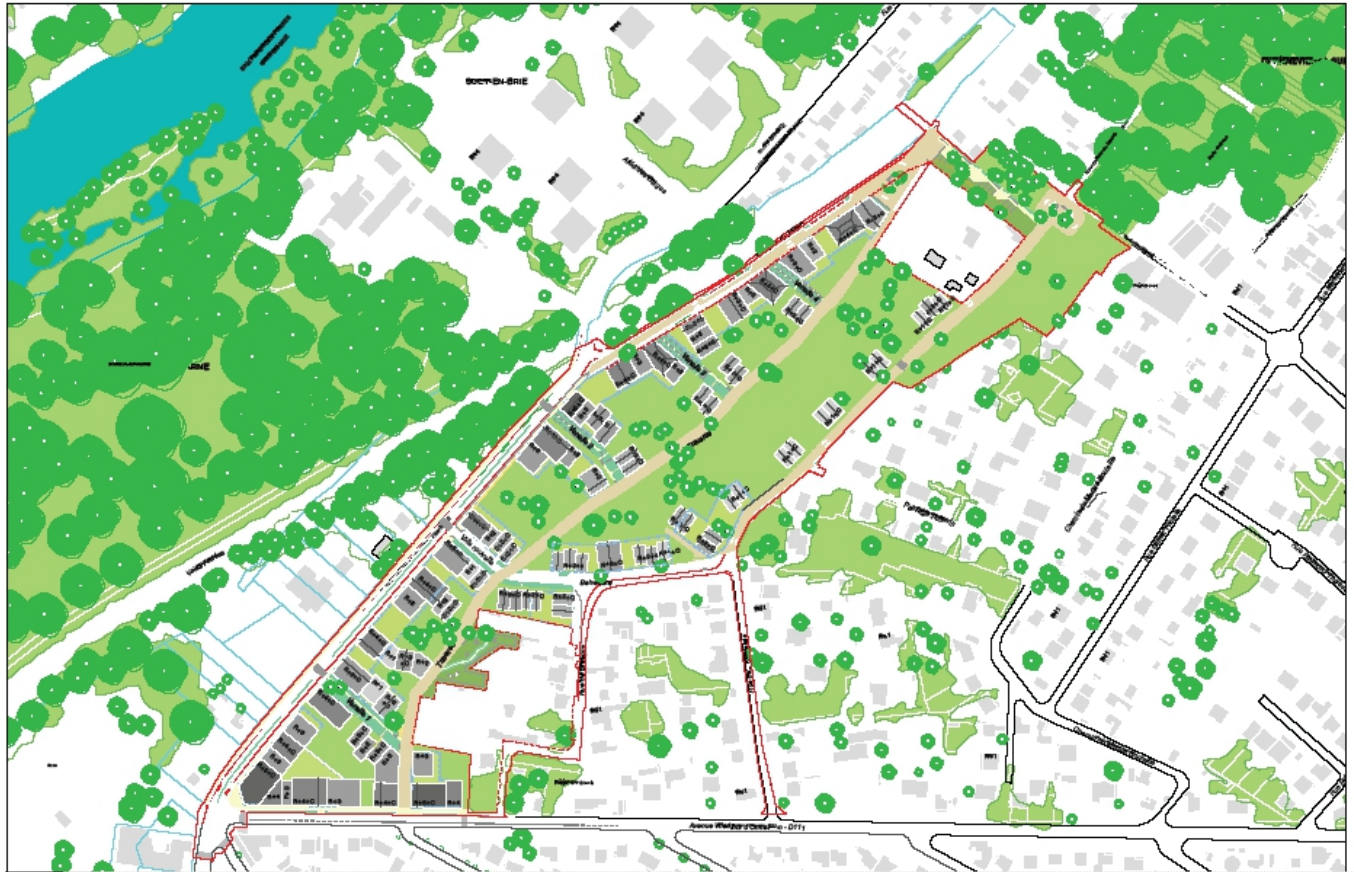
Plan d'aménagement de la ZAC d'Ormesson
